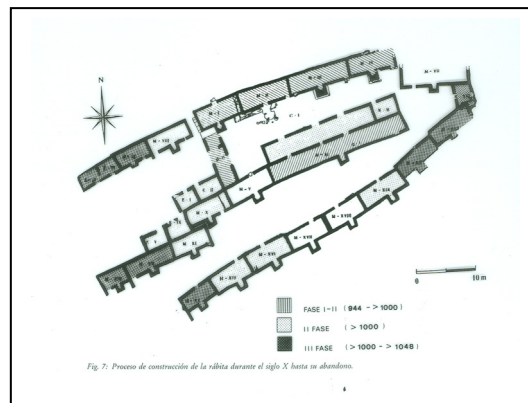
Plano del conjunto arquitectónico de la Rábita de Guardamar
